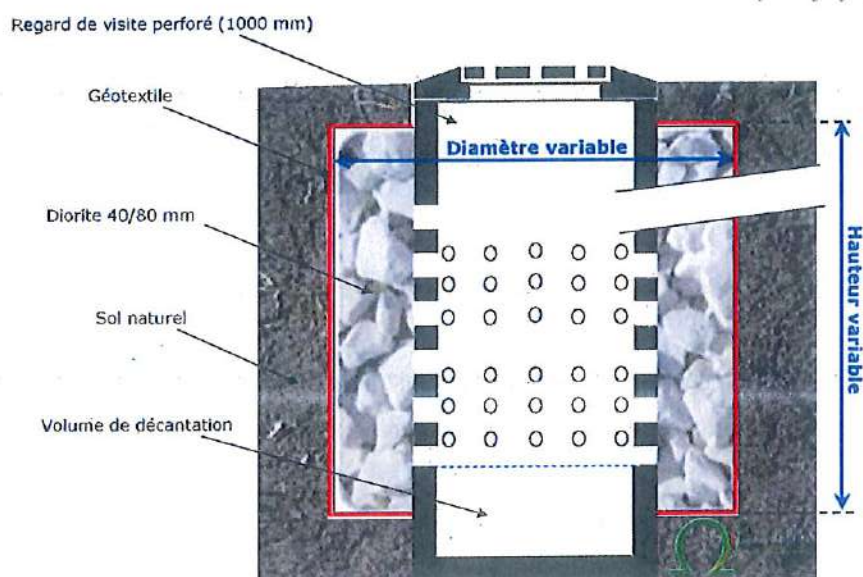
coupe de principe d'un puits d'infiltration pour les eaux de toitures
